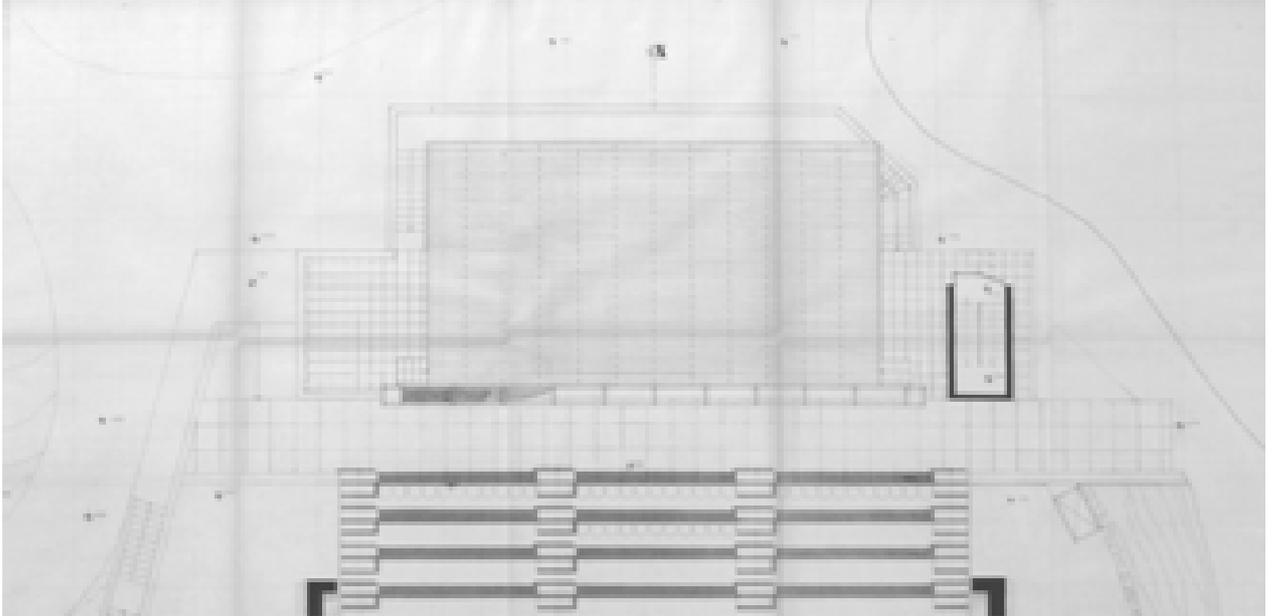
Pianta teatro all'aperto, stato futuro – opere di completamento – 11/06/1997 (AABS-693)
